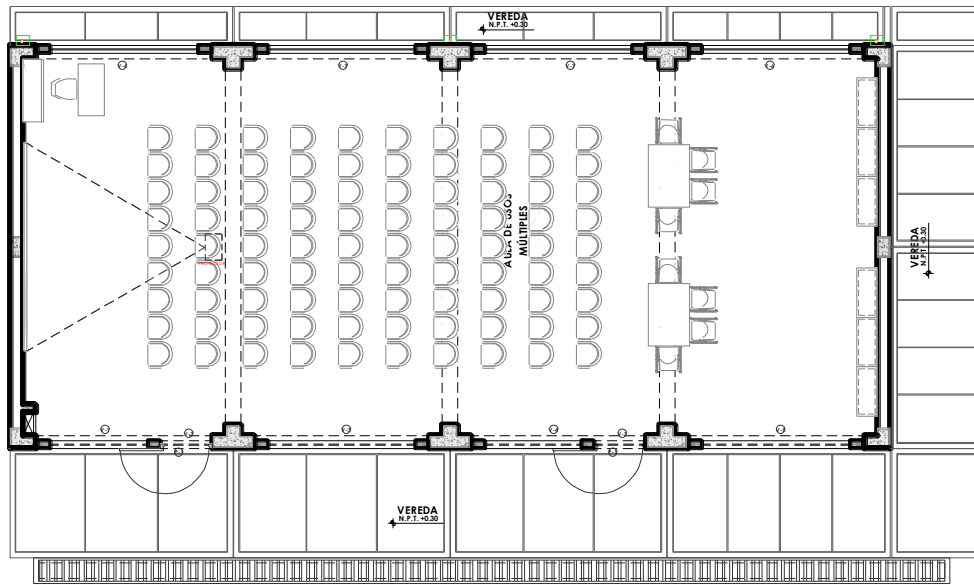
Planta arquitectura del Bloque V (Primer piso).
